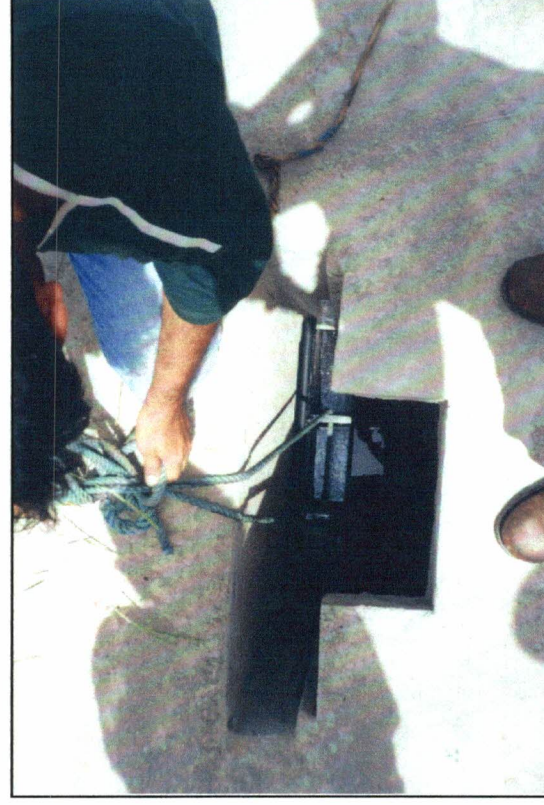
Colocação do stop-log nas guias em aço inox, já "chumbadas" na caixa de concreto.
